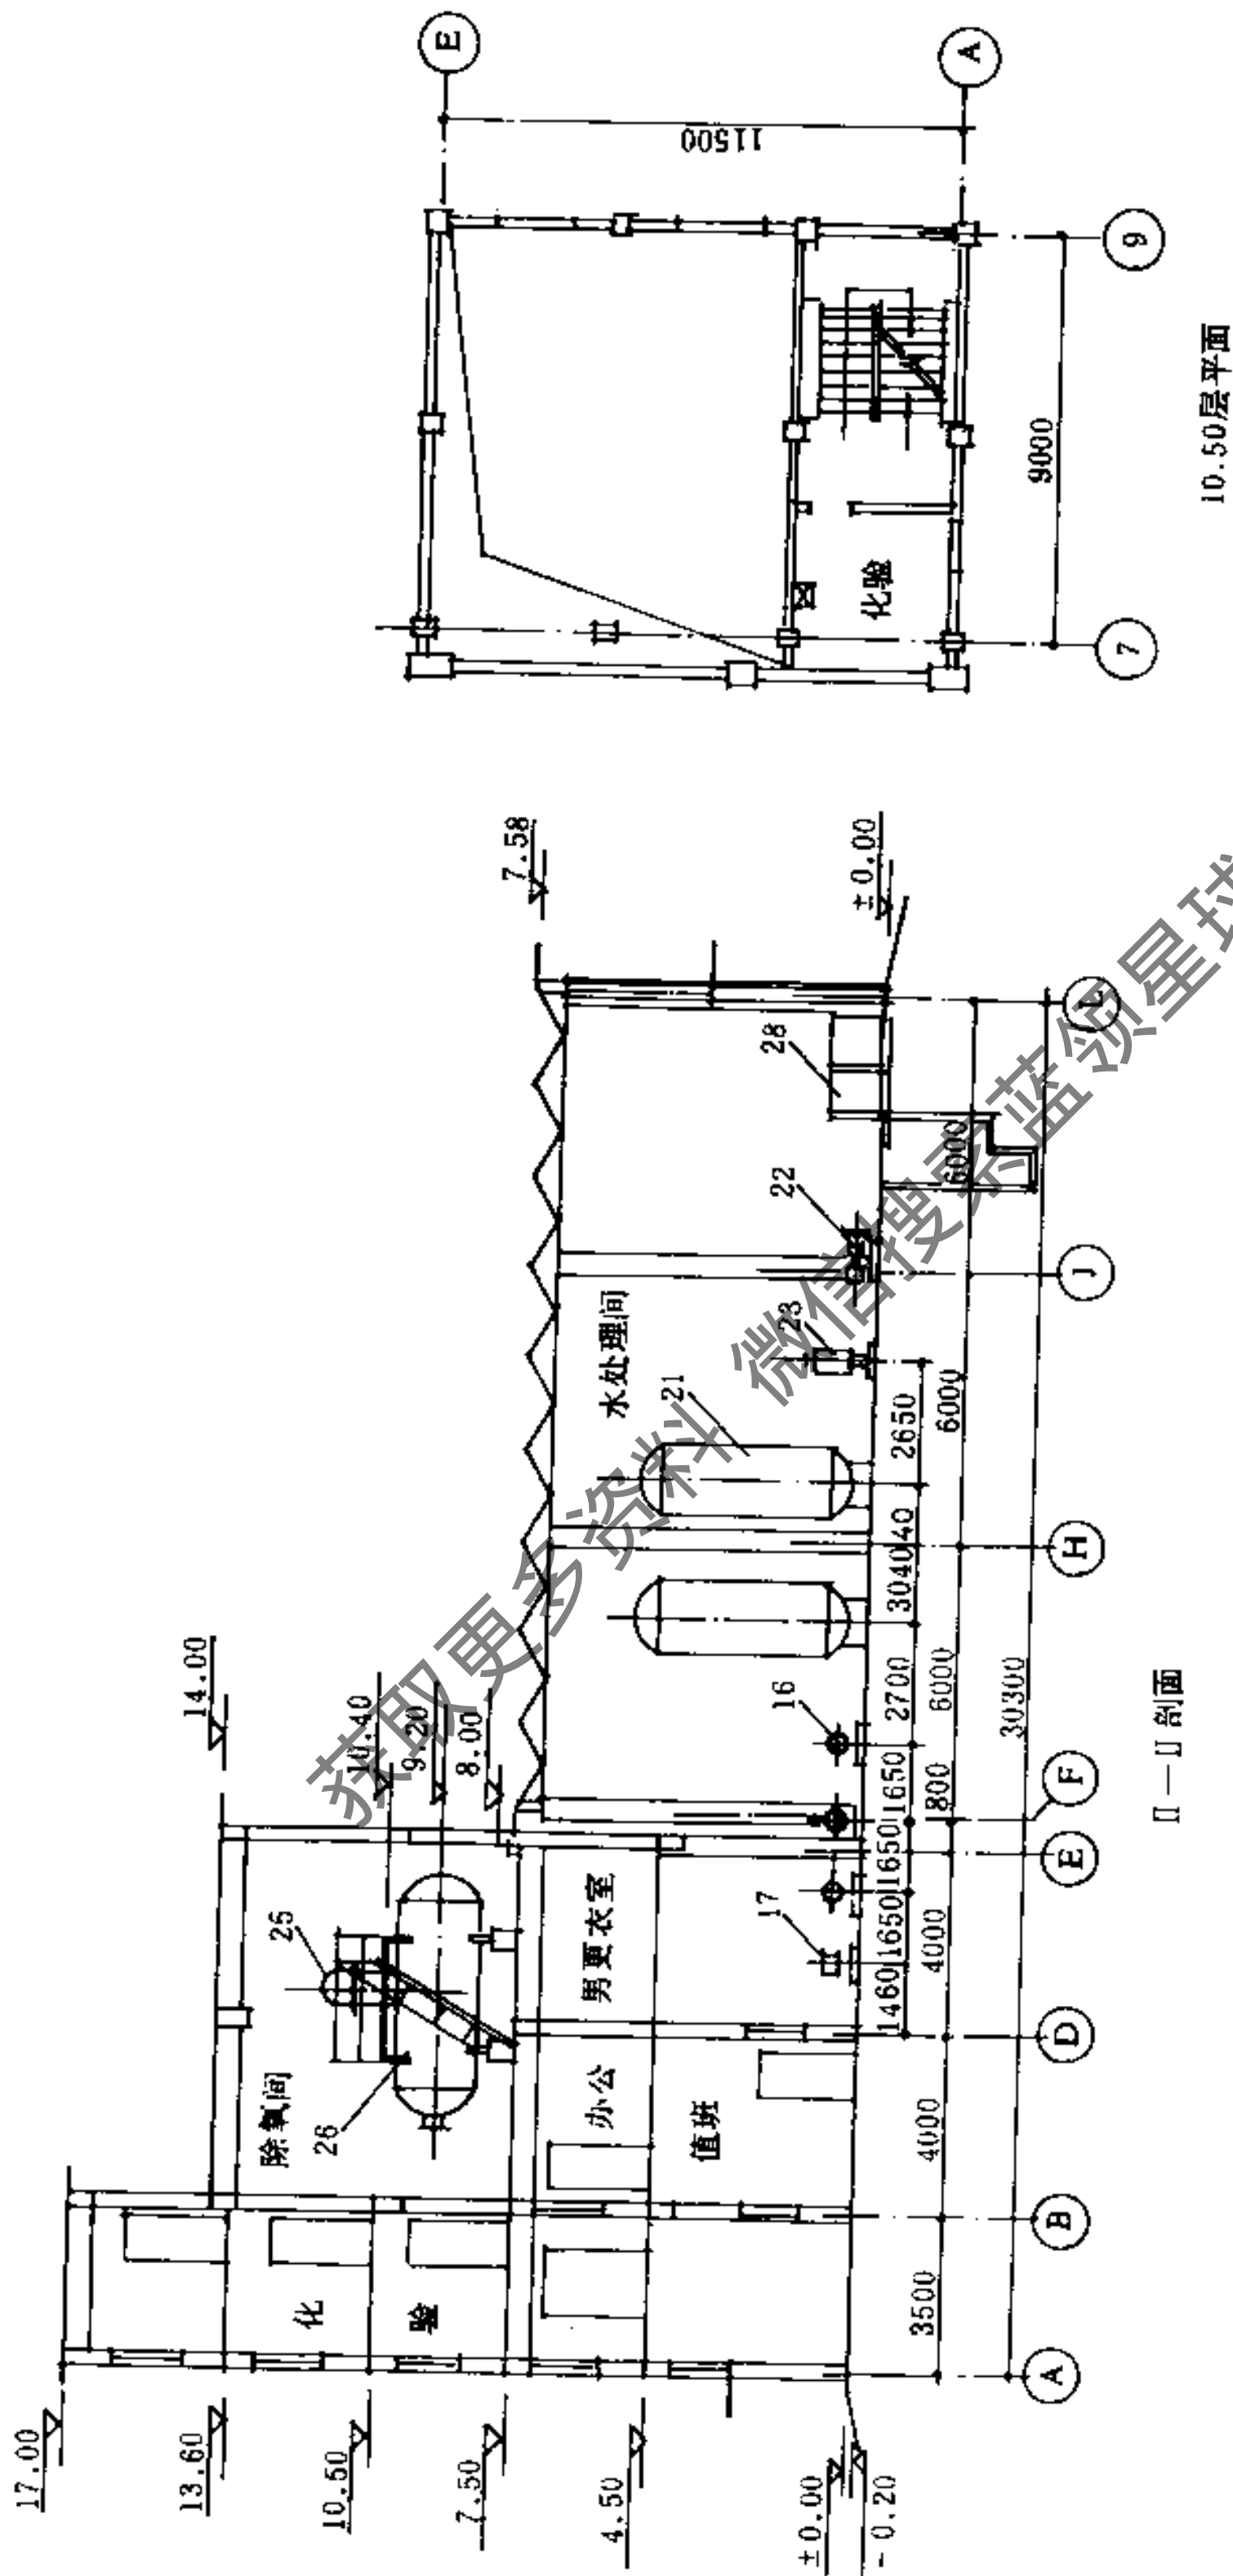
三台SHL-10-13 A型锅炉房10.50平面图及II-II剖面图
